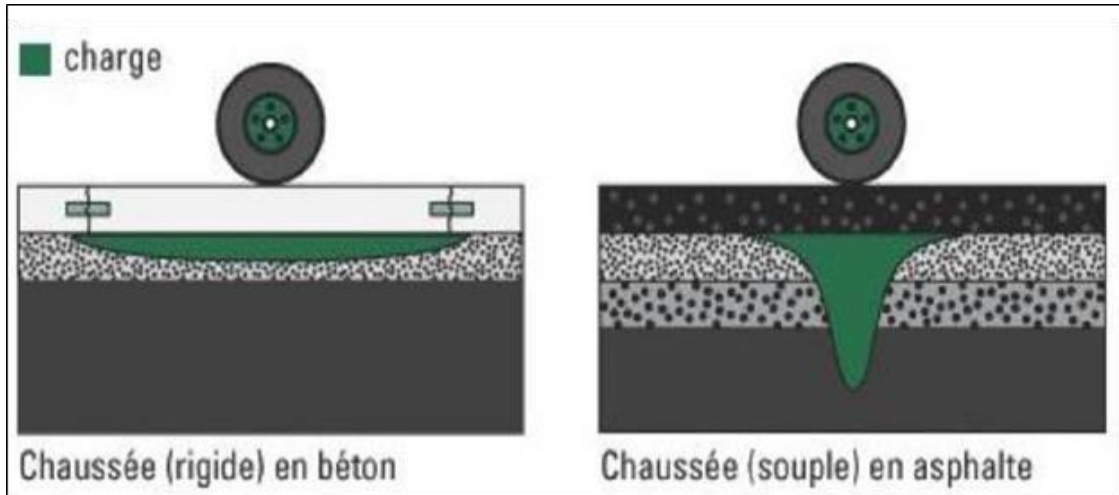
Répartition de la charge sur la chaussée béton ou asphalte
